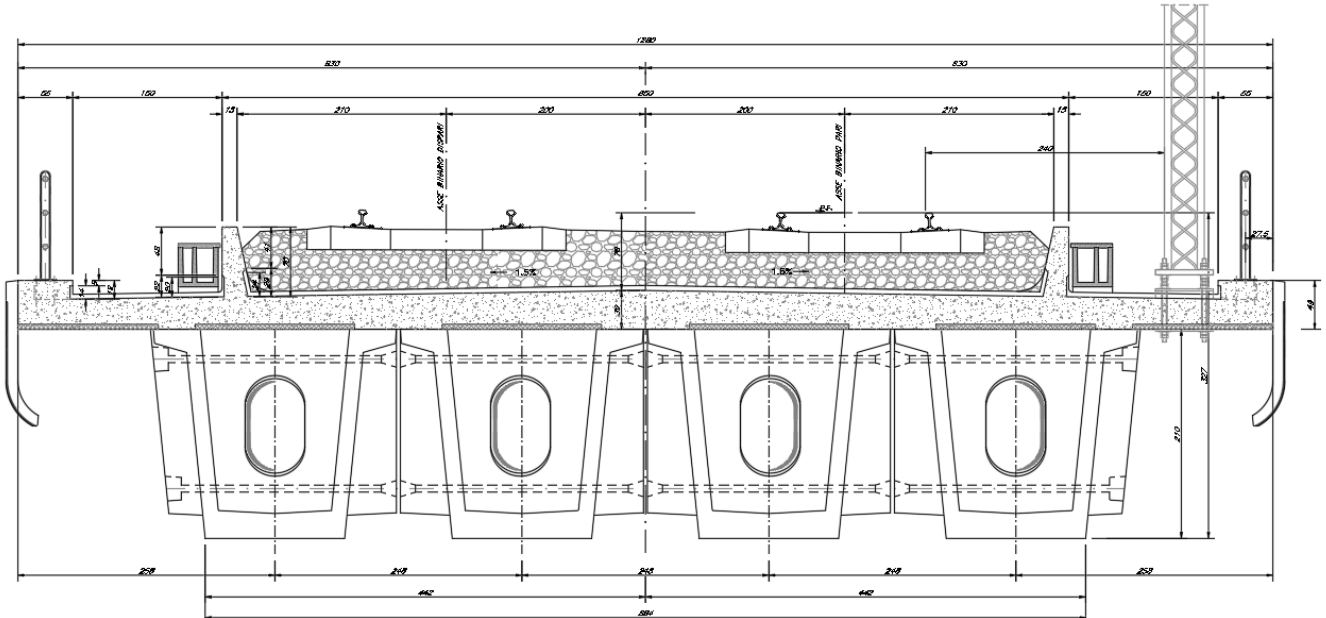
Sezione tipo viadotto c.a.p. L=25.00m
